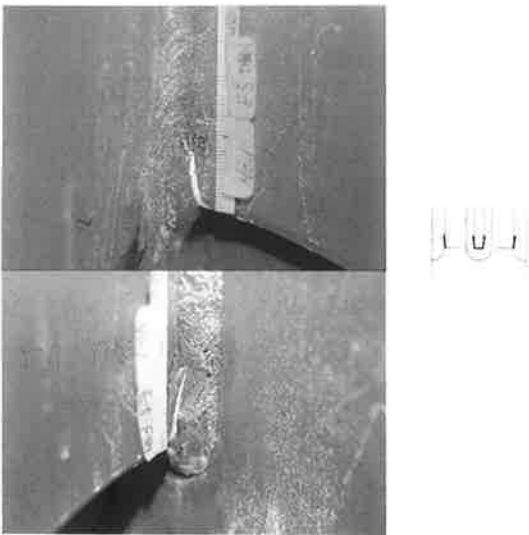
まわし溶接部の割れ (b-タイプ)
